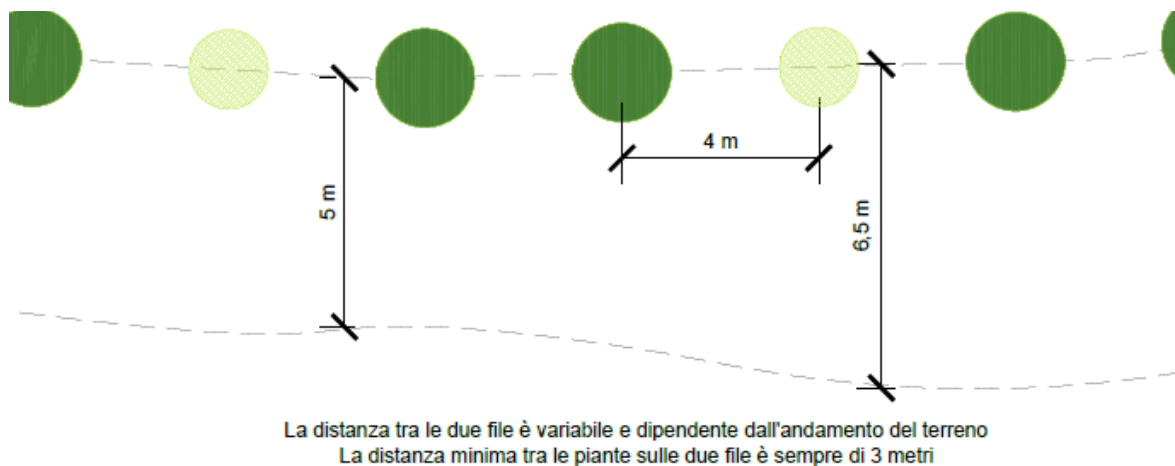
dettaglio del sesto di impianto da rispettare lungo le file di piantagione delle piantine forestali
